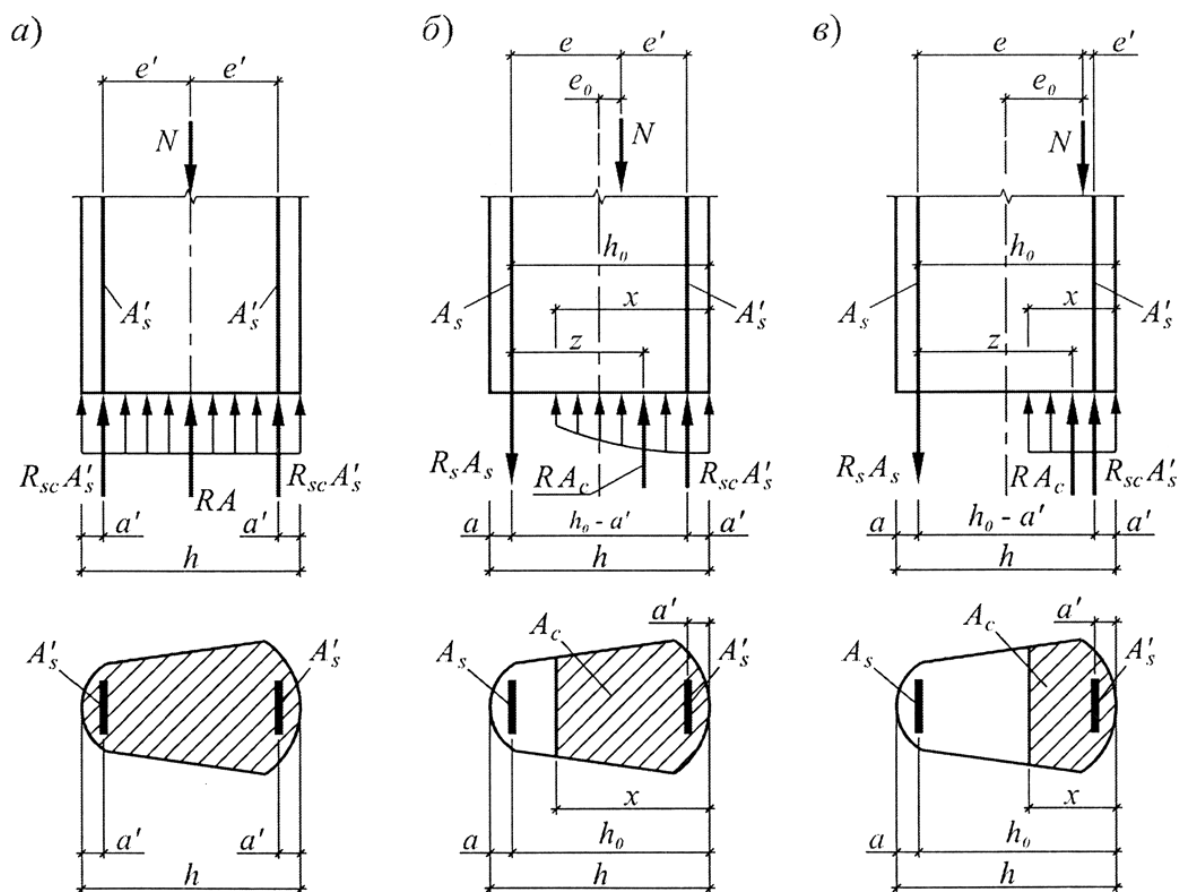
К расчету сжатых армокаменных конструкций с продольным армированием:
